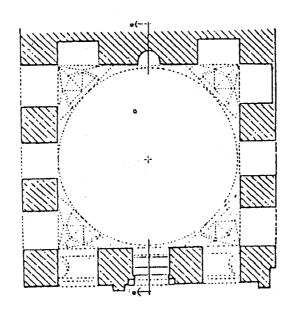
مسقط أفقي لجامع مراد باشا بالقاهرة.
